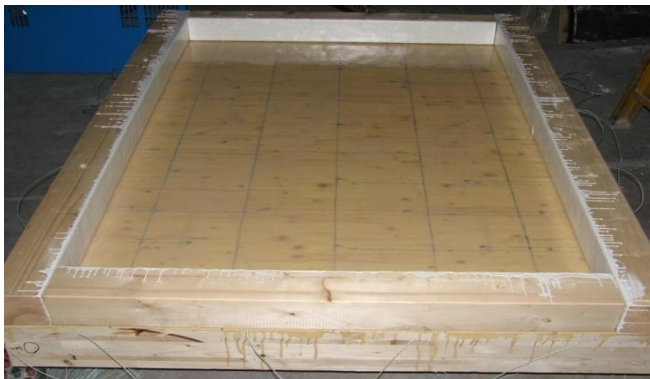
Kleinbrandversuch (2): Deckenbauteil vor dem Einbau; Beschichtung K15 transparent [INO09]
